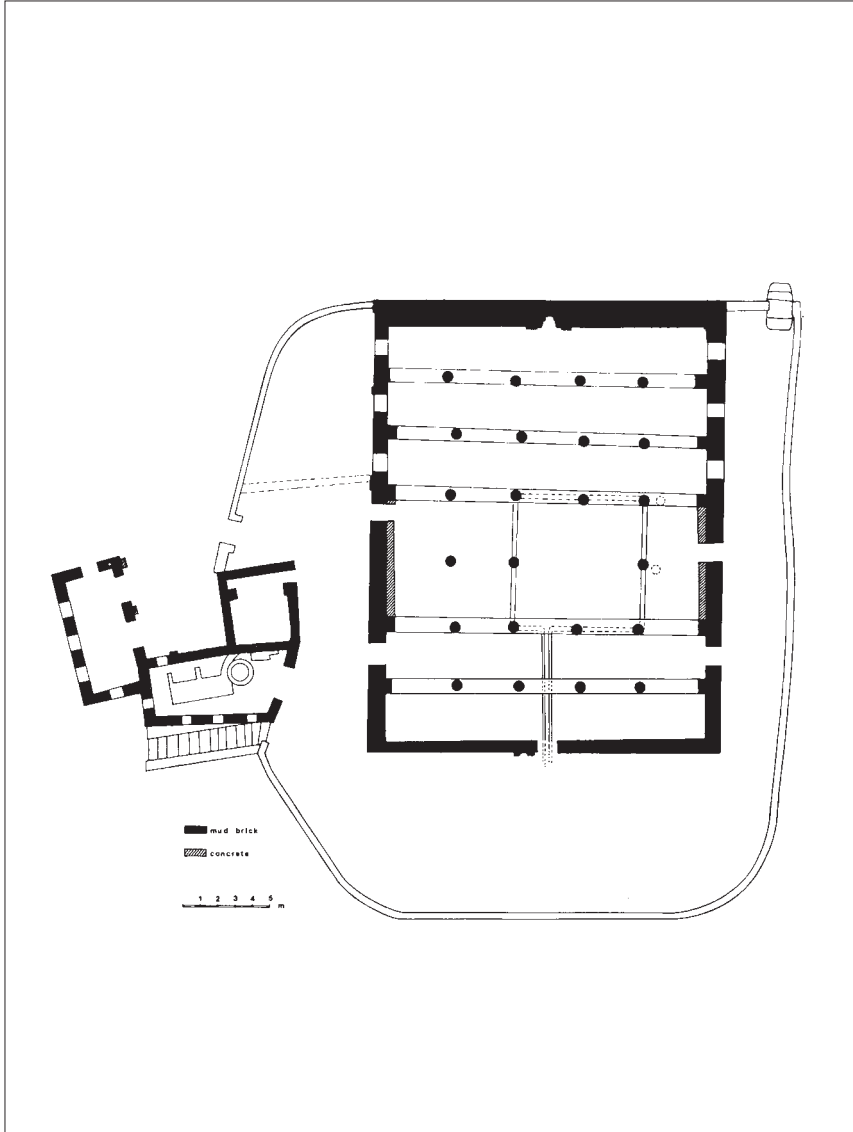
/ب): مسقط أفقي لمسجد النبي ﷺ قبل التوسعة سنة ٢هـ
